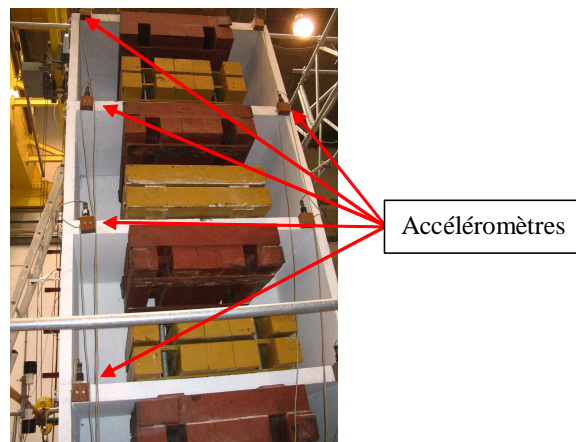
Maquette ECOLEADER : Plan de disposition des accéléromètres
